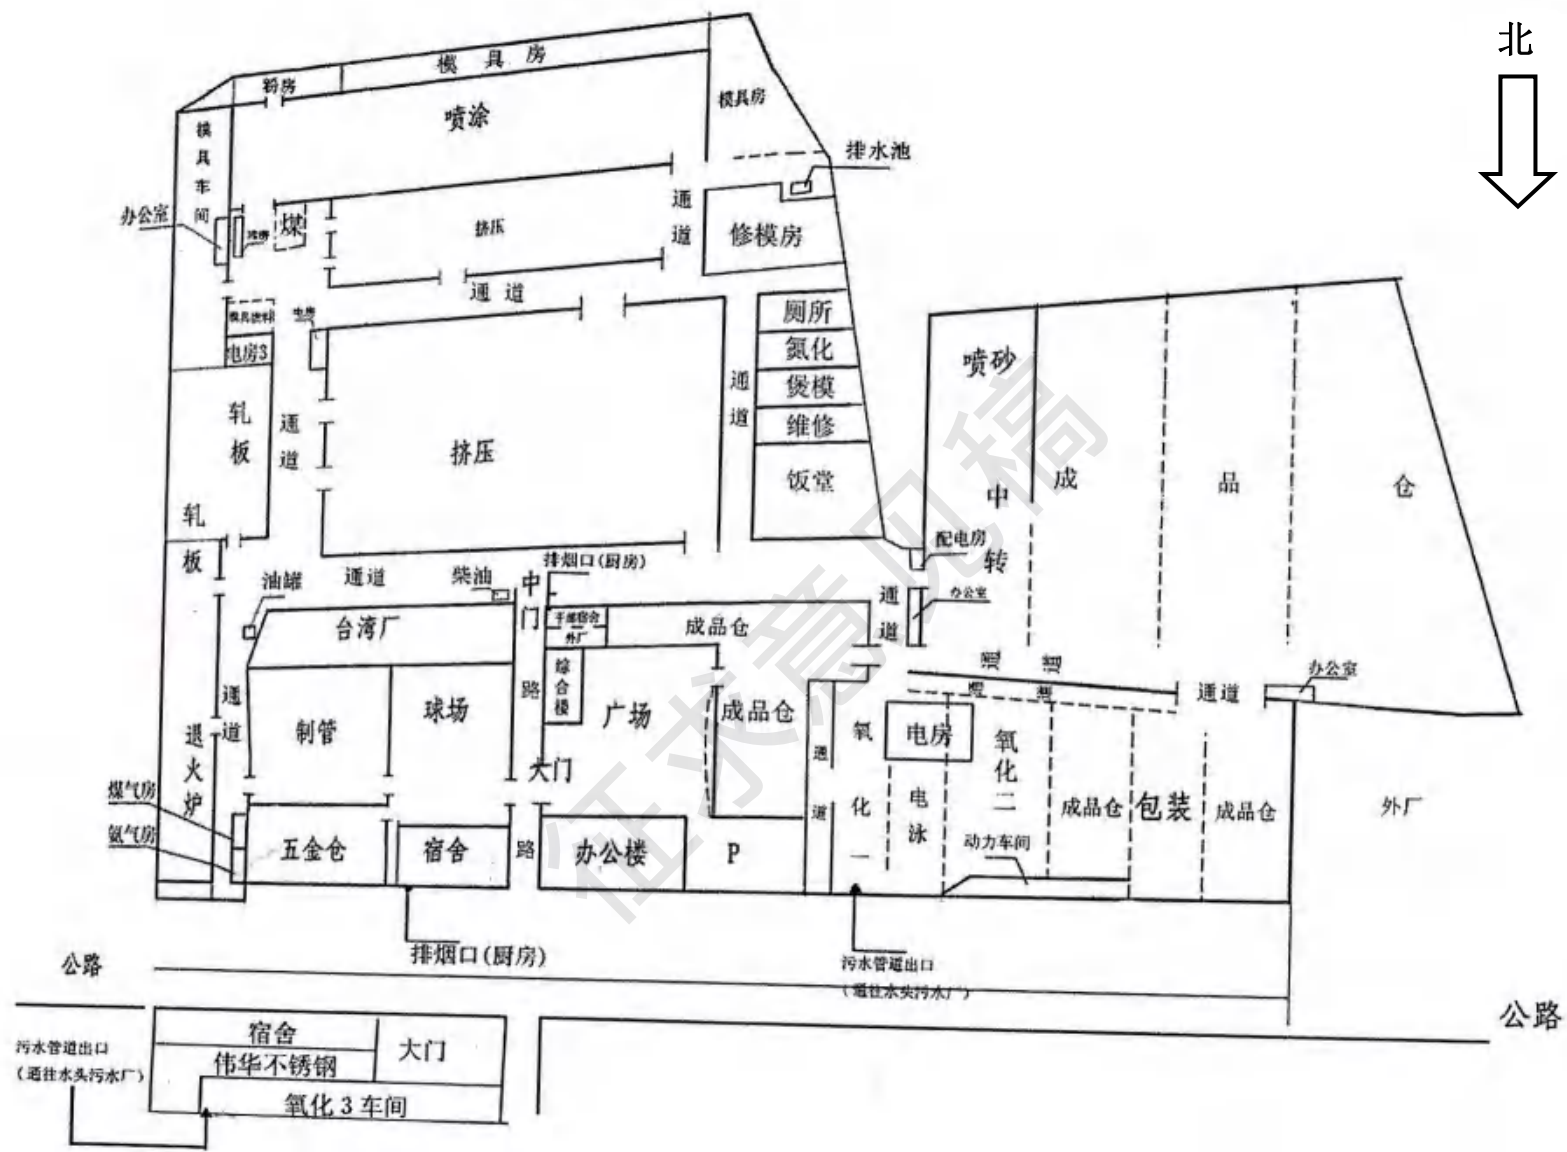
原项目（大沥分厂）厂区平面布置图
